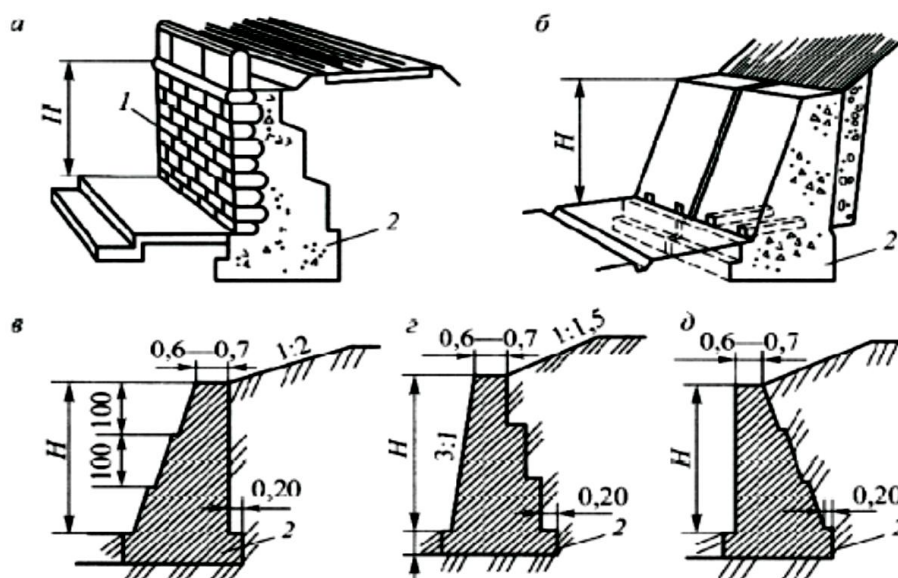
Бетонные и каменные подпорные стены:
